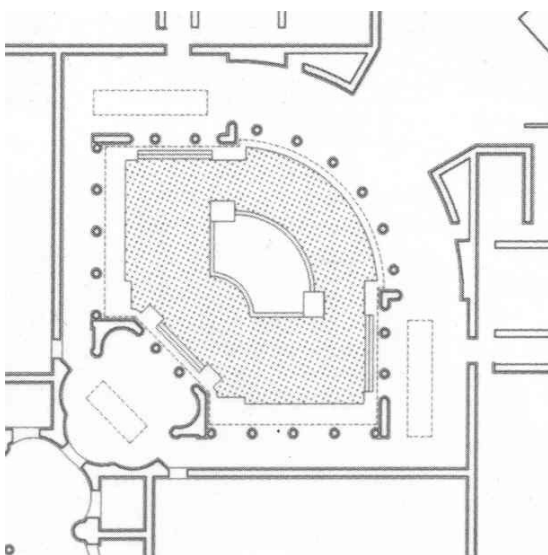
Planta galería y patio. Museo de Bellas Artes (1935-36) (P. Villanueva y M. Pintó).
